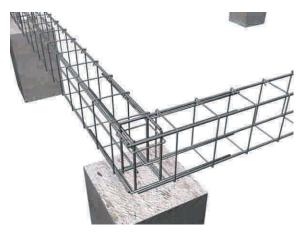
12: Encuentro de esquina de la viga de fundación, donde los fierros del pilote de hormigón pasan a formar parte de la enfierradura de la viga.
